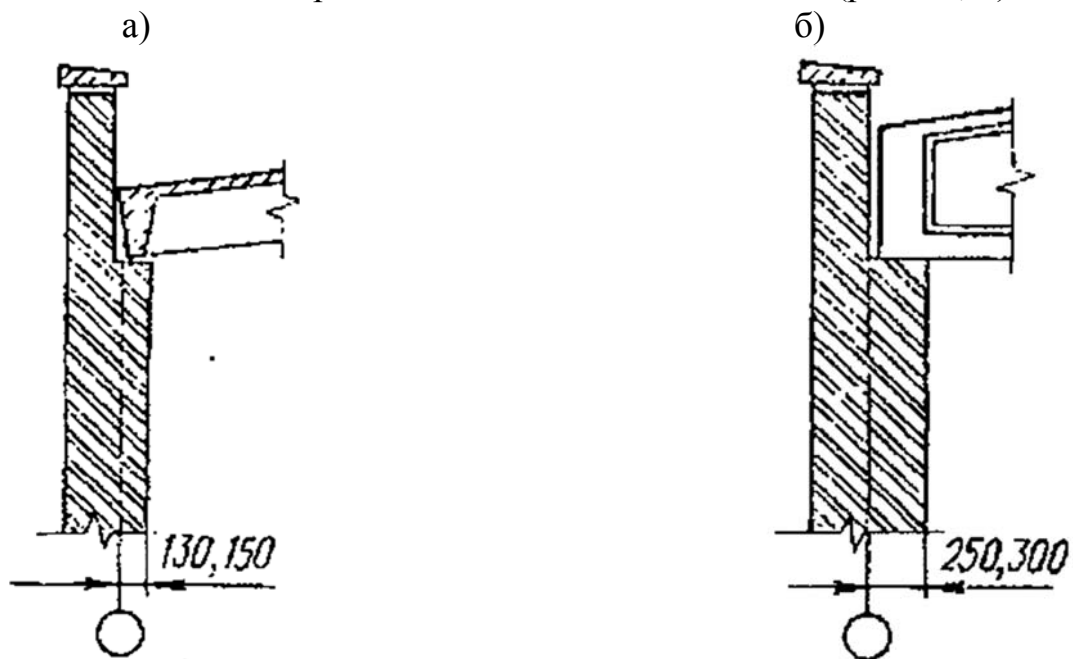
Привязка несущих наружных стен из крупных блоков и кирпича к продольным осям здания
